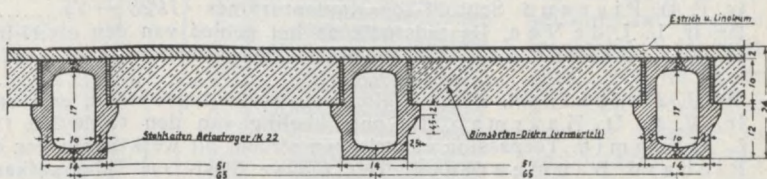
Doorsnede van een vloerconstructie met Stahlsaitenbeton-liggers.
